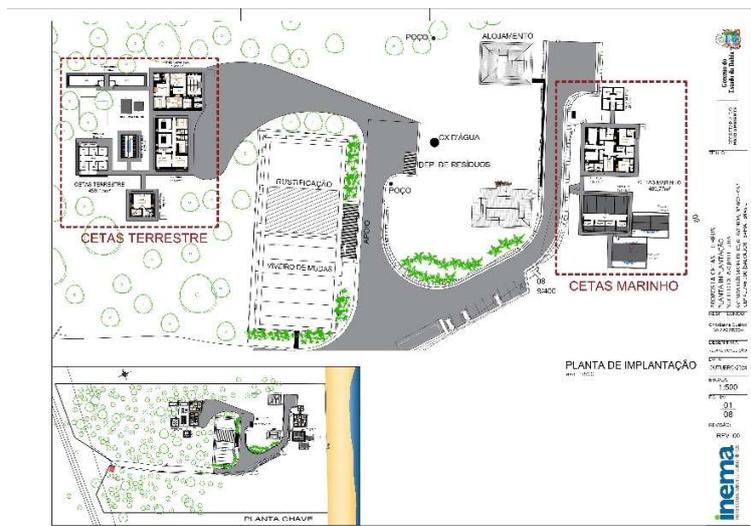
Planta baixa de implantação dos CETAS Sul (CETAS Terrestre) e CETAM (CETAS Marinho) (Fonte: NEARQ/ INEMA).
